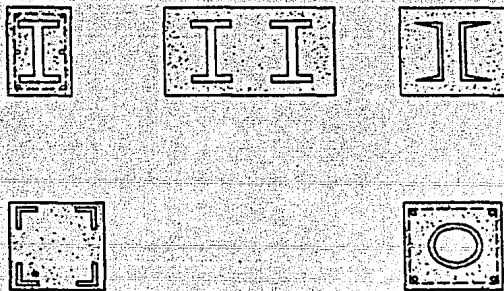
COLUMNAS DE ACERO RECUBIERTAS CON CONCRETO.
